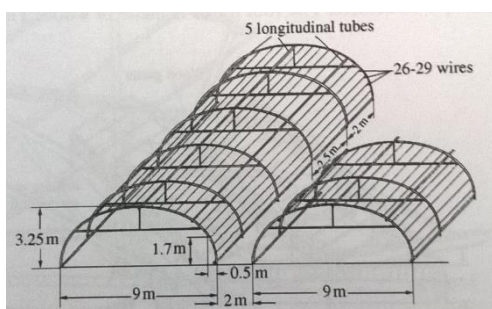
Estufa Wide-Span com ventilação lateral e no telhado | Fonte: (13)
